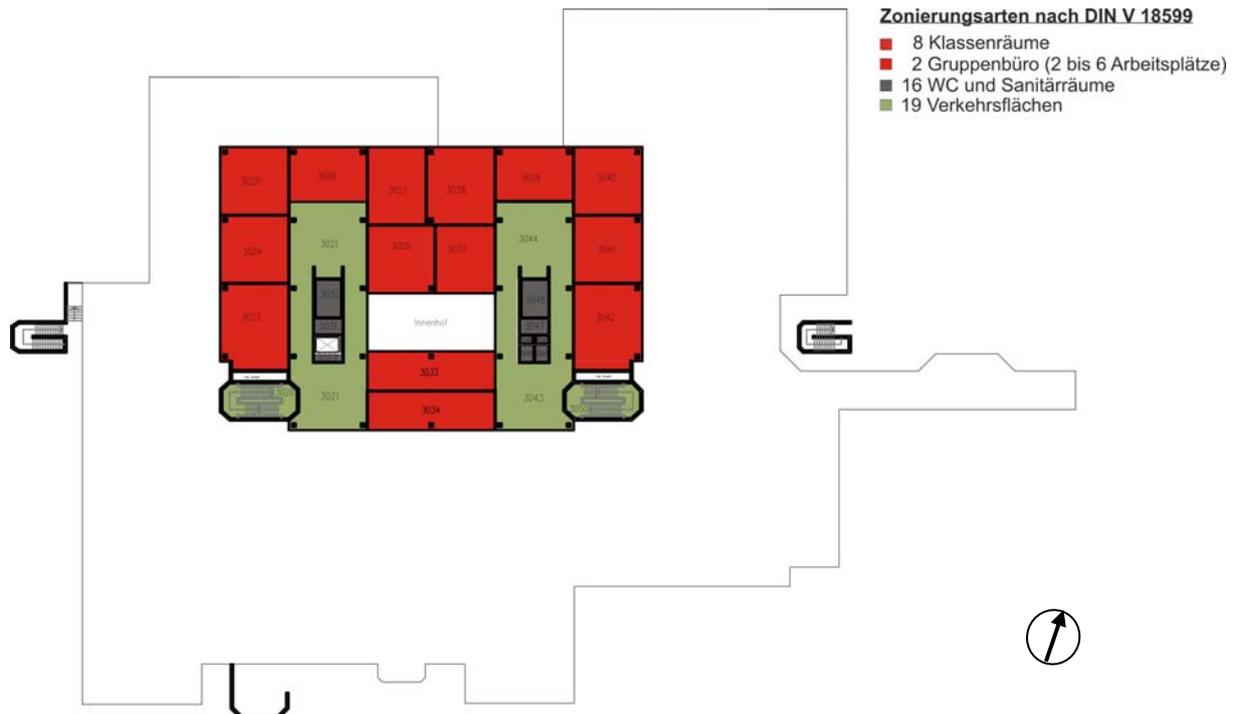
Haupt- und Realschule Grundriss 1.OG Bestand
